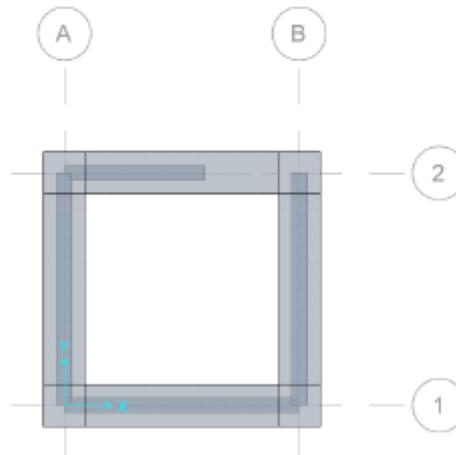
Vista en planta de la propuesta de cimentación, compuesta por cimentación corrida.
